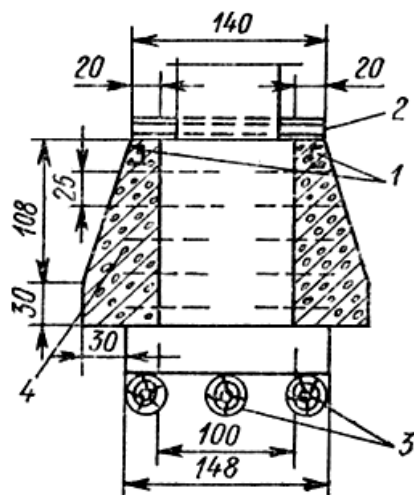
Конструктивные решения по уширению подошвы фундаментов устройством бетонных приливов
